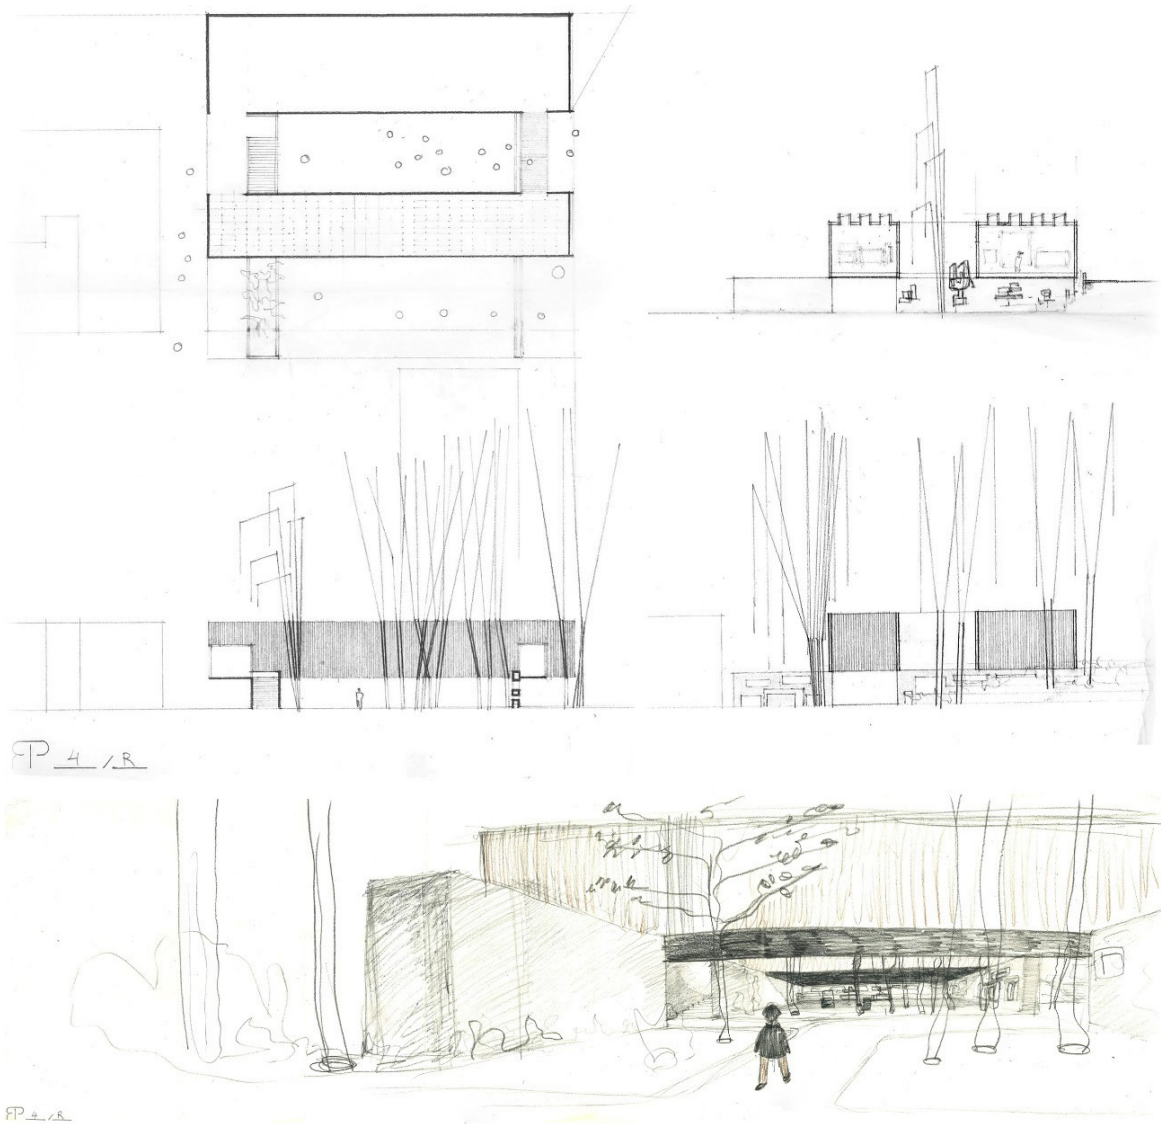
Planta alta, alzado, secciones y vista exterior de la propuesta 08. 1958, Reima Pietilä.
